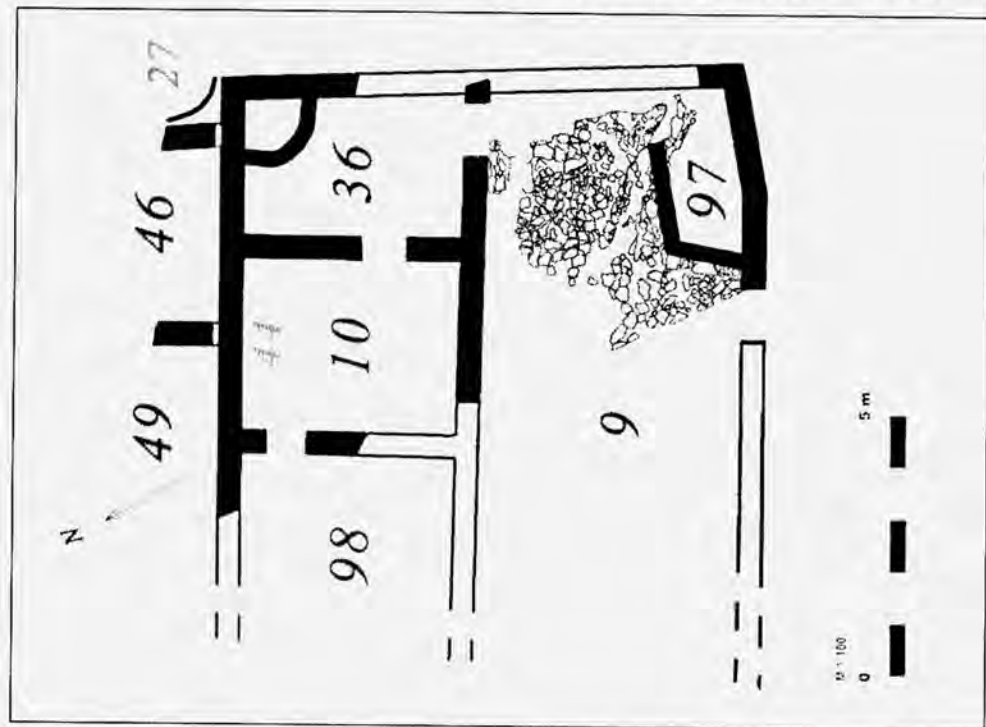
План дома 1 – 1. Реконструкция С.Д. Крыжицкого.
